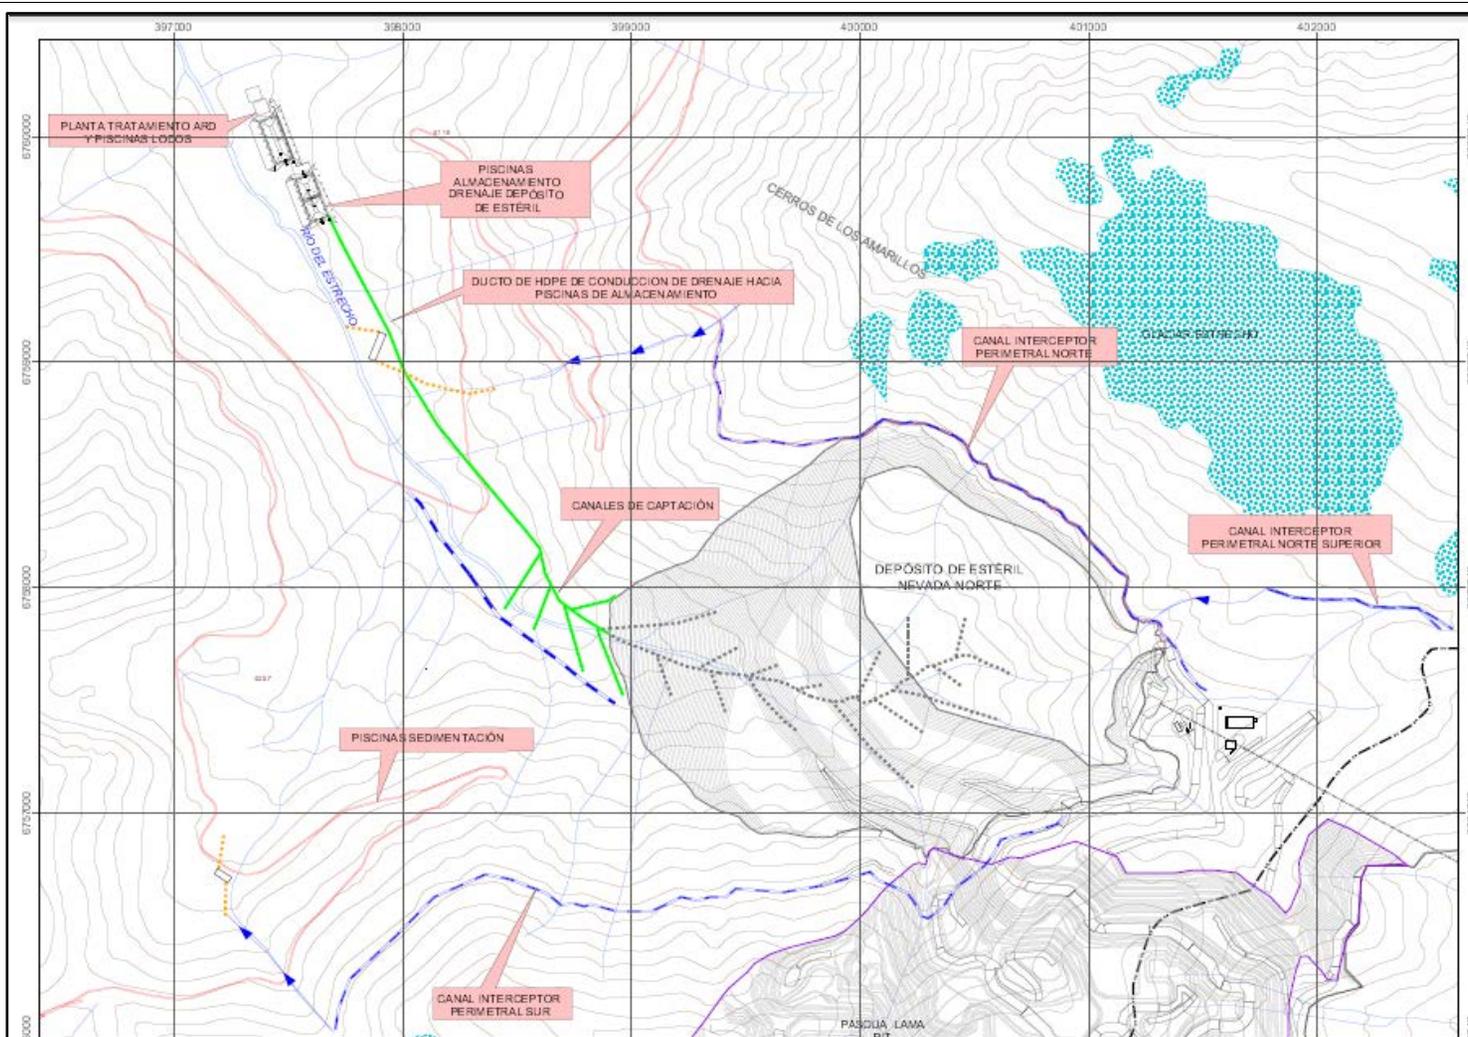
Layout Sistema de Manejo de Drenajes y Depósito de Estériles (Fuente original: EIA “Modificación Proyecto Pascua Lama”).
